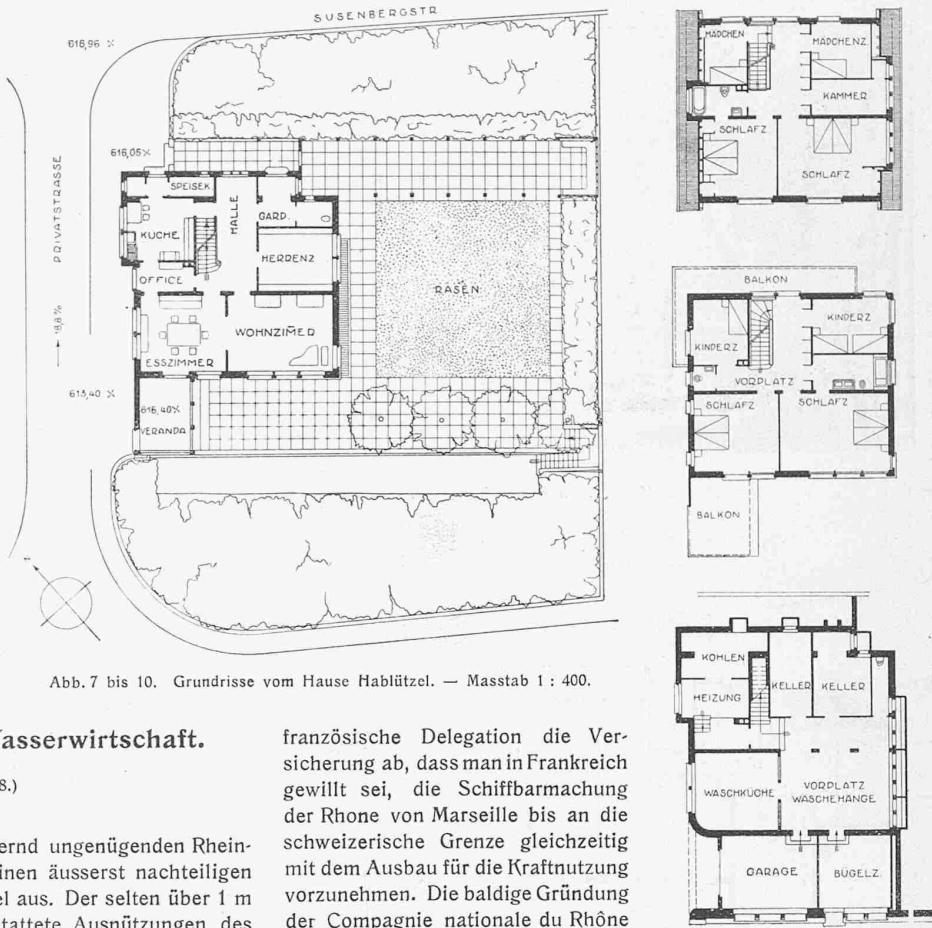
bis 10. Grundrisse vom Hause Hablützel. — Masstab 1 : 400.
